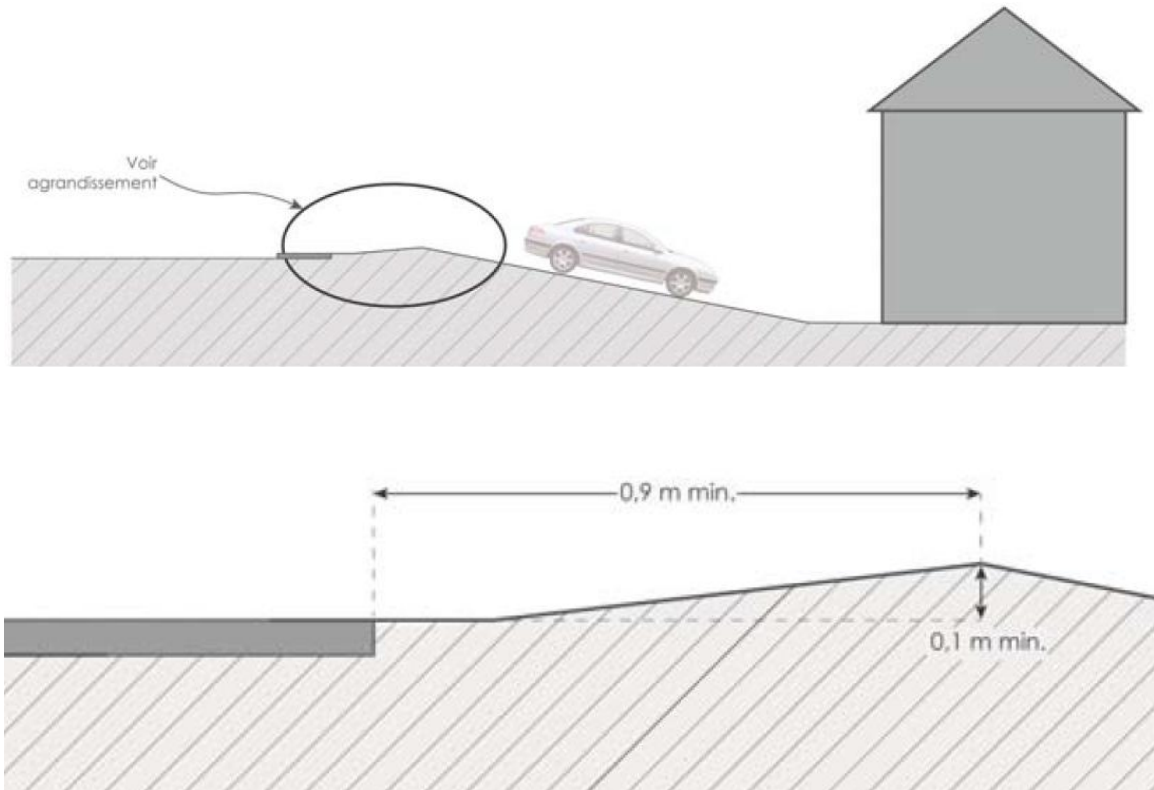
Figure XX Exemple de rehaussement pour une aire de stationnement en pente
